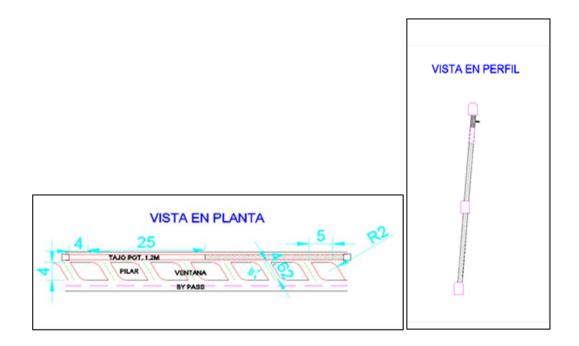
Vista en planta de la zona inferior y vista en perfil.
